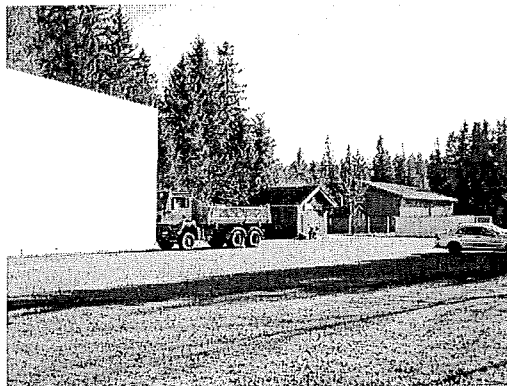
Blick auf Parkplatz, Bergwachtgebäude und Salzlager
